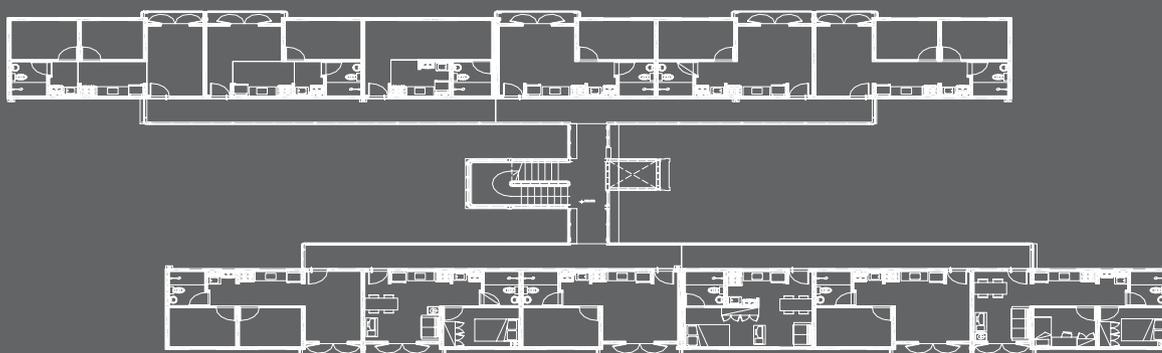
Projeto arquitetônico do Parque do Gato. Planta do pavimento tipo.
